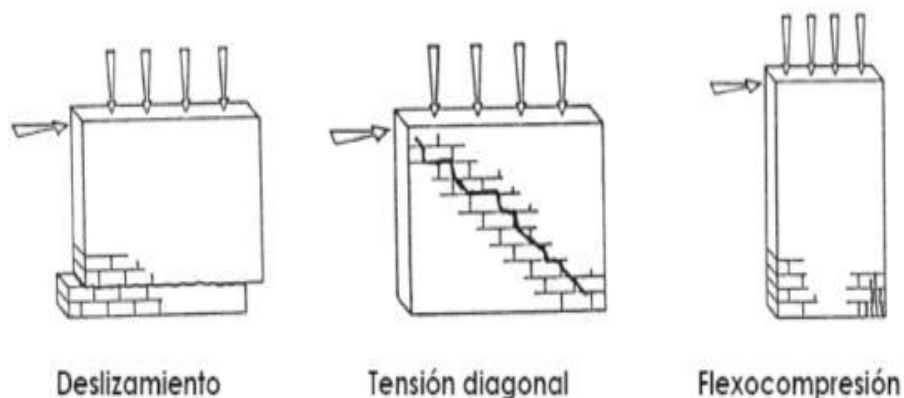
Posibles modos de falla en un muro de mampostería.
